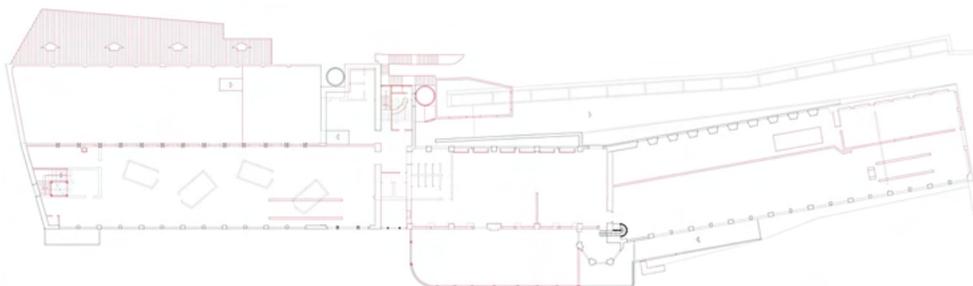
Planta existente do piso 2. A vermelho as alterações propostas.
